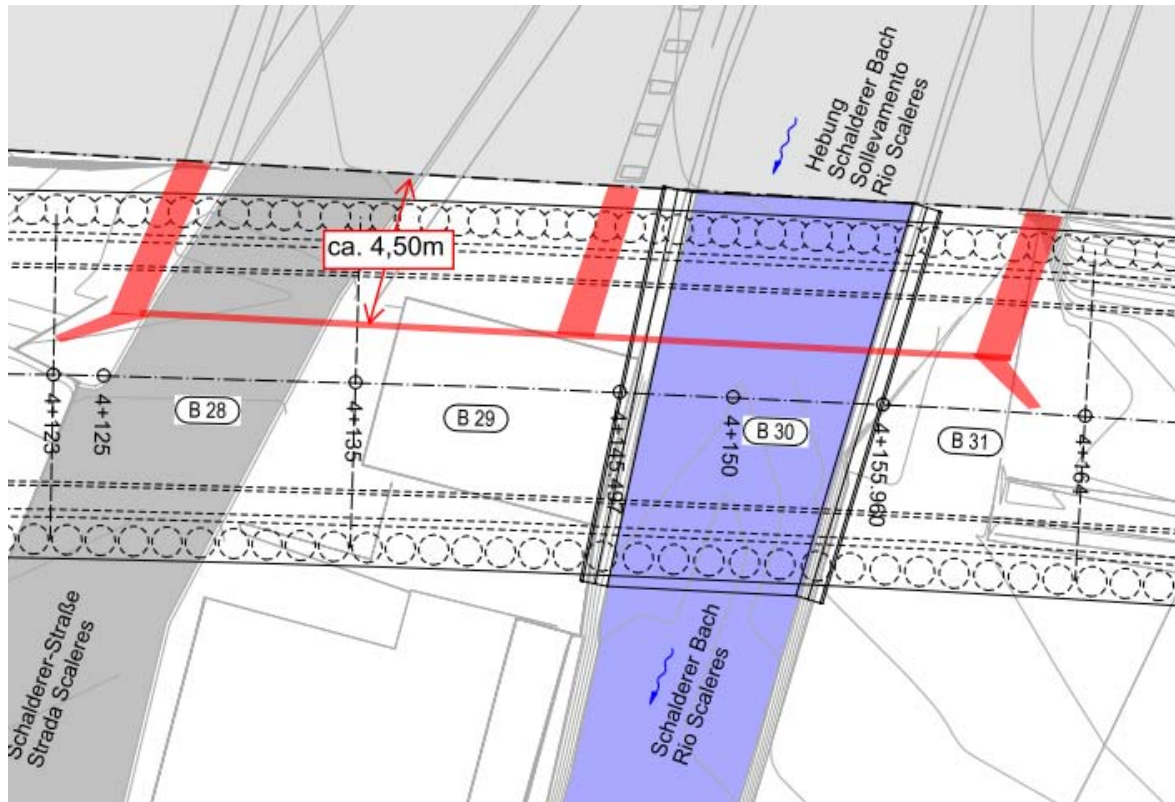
Planimetria intersezione autostrada in zona ca. km 4+125 - km 4+160
